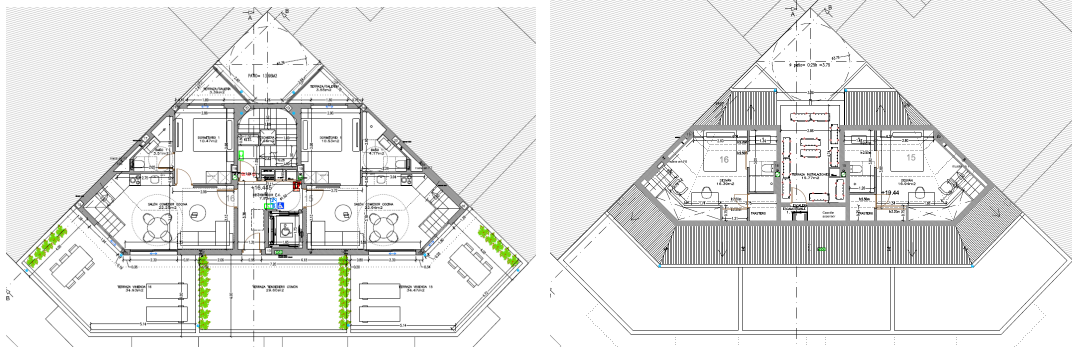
y 6 – Planta Ático y Bajo Cubierta.
